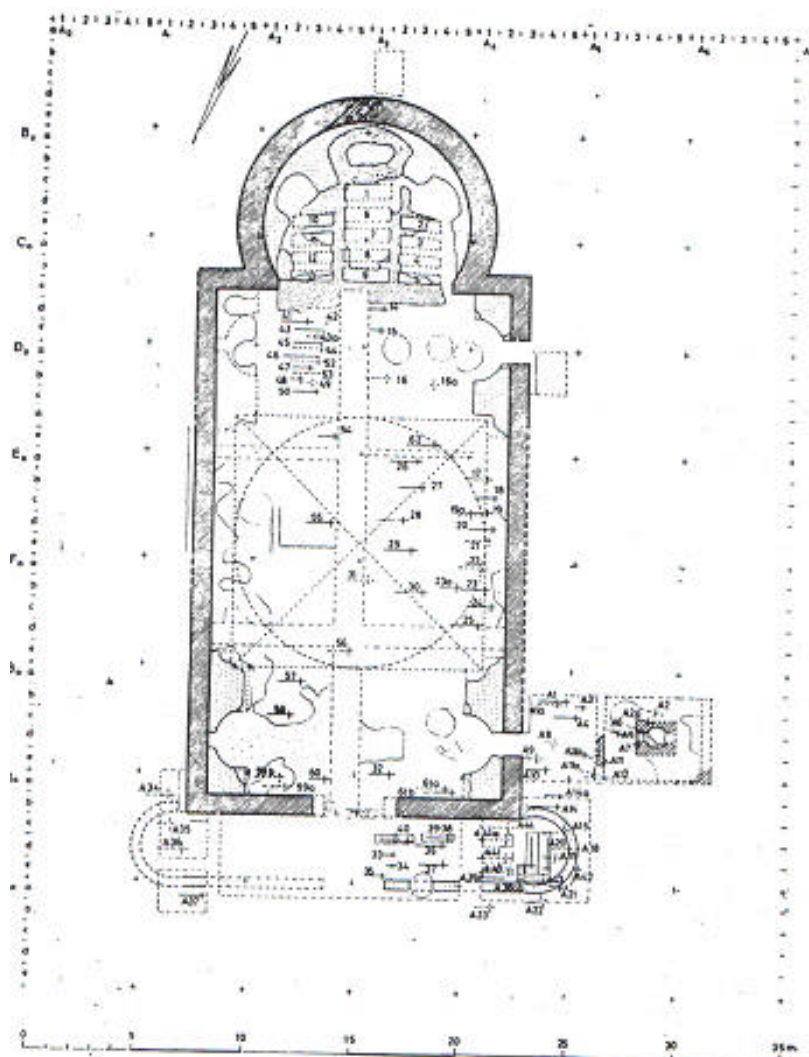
Basílica martirial de Marialba. Planta (según Hauschild, 1968)
